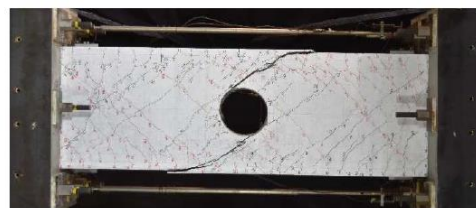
試験体破壊状況 (No. 3 : H/D=1/2.5)
